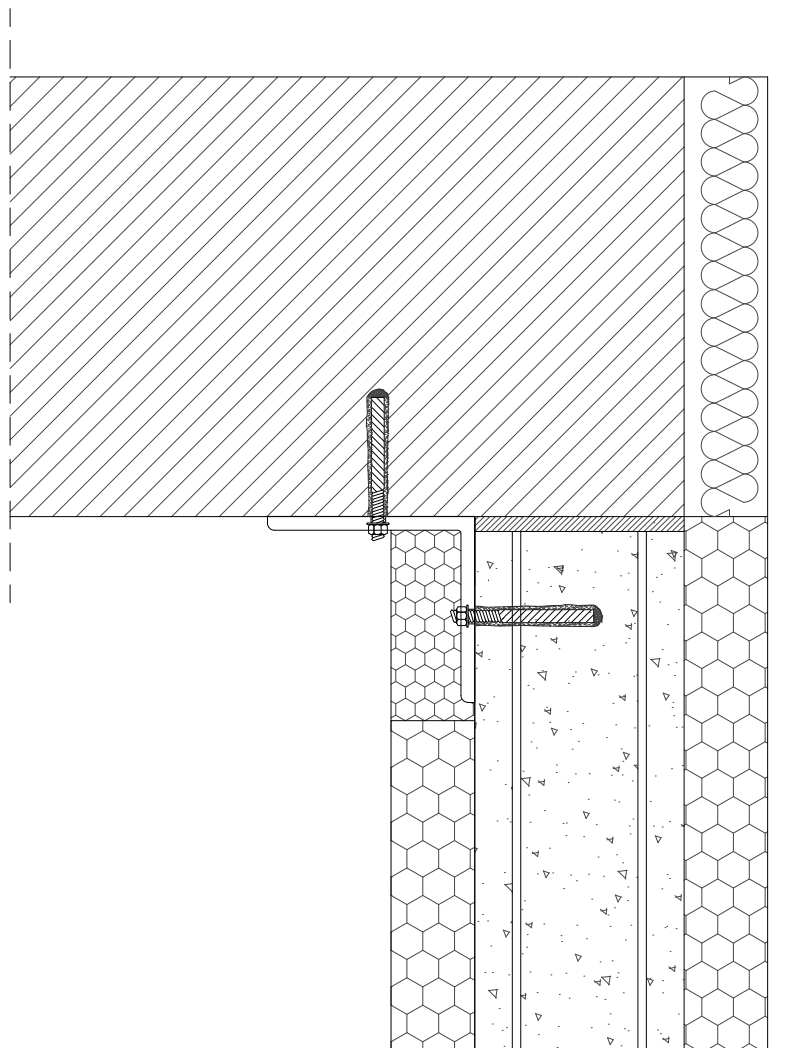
Collegamento tamponamenti mediante angolari (sezione).
